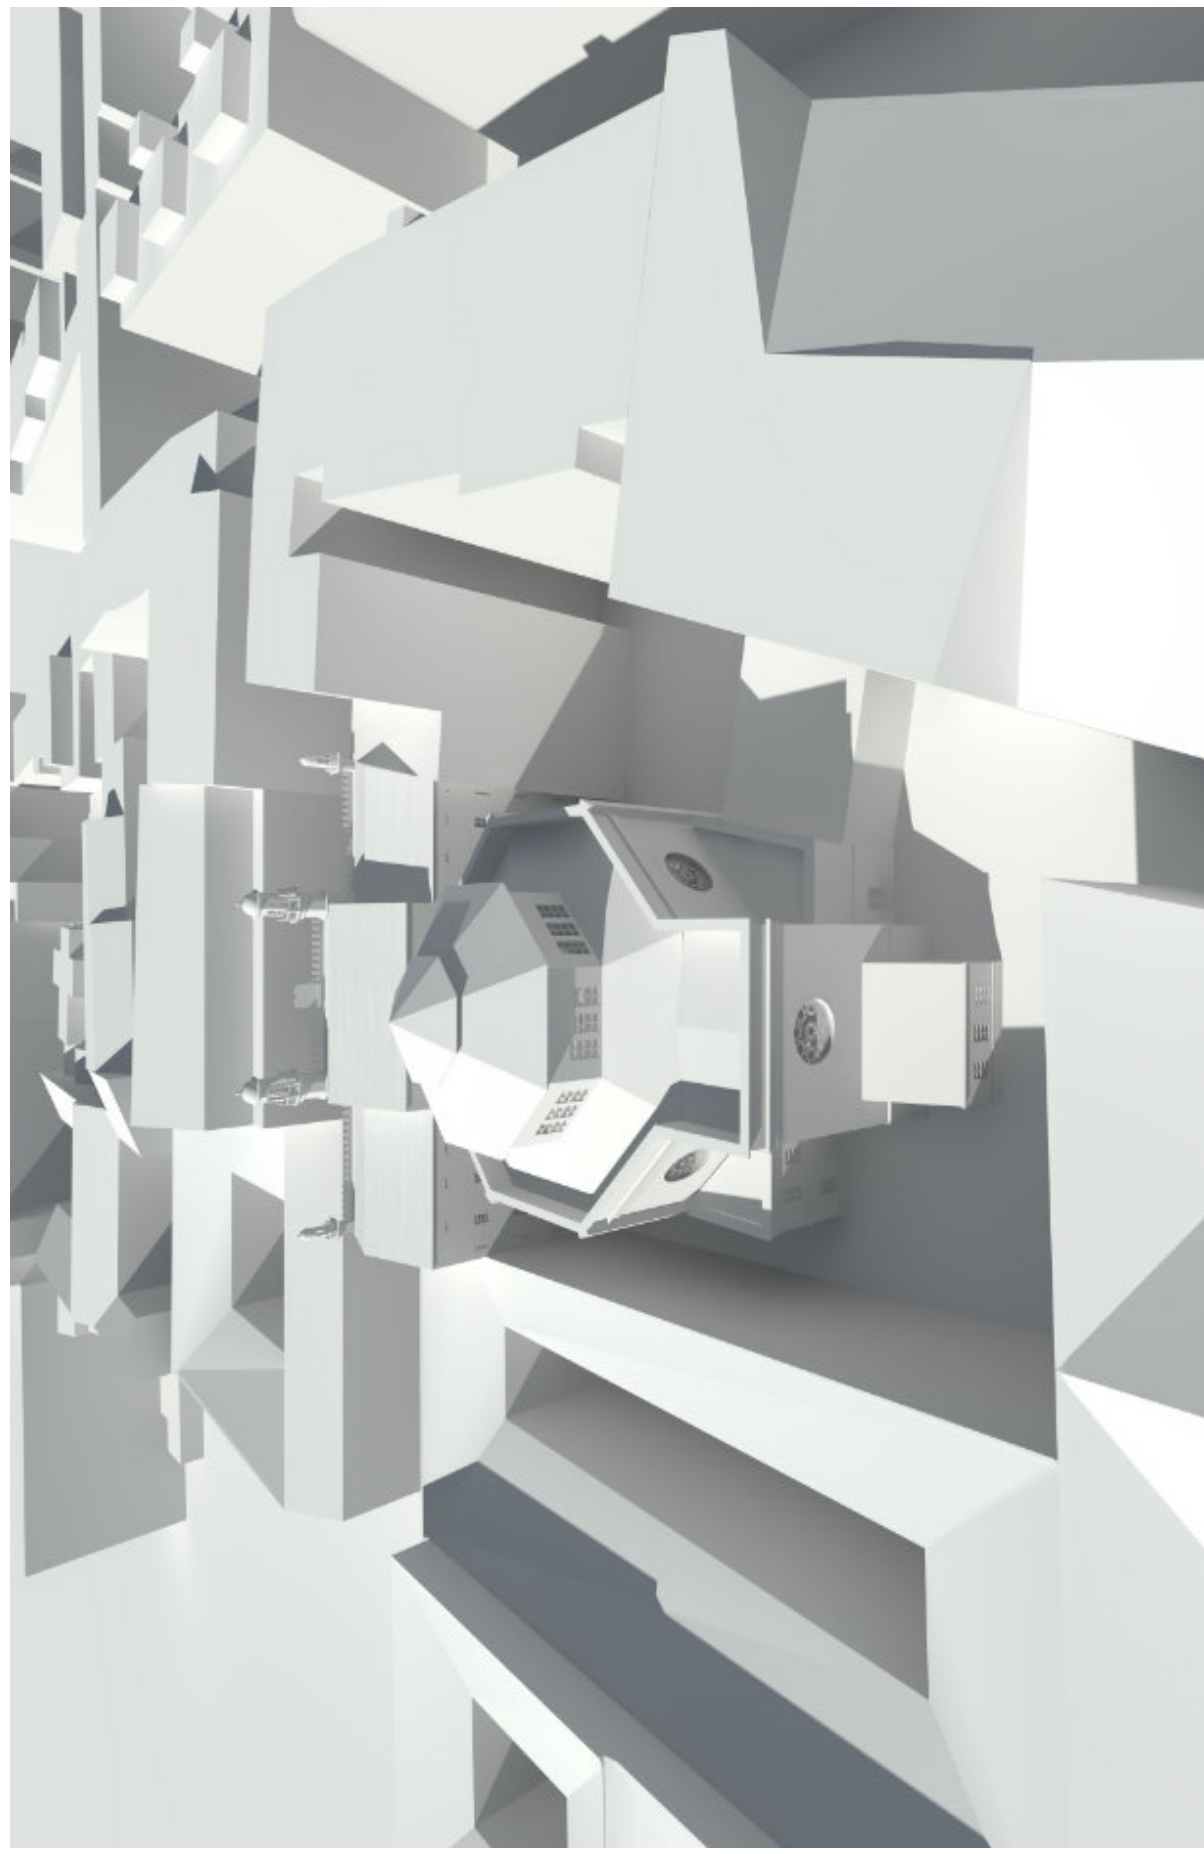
4b.: Außen 03 - Ostfassade, Städtebauliche Situation, Weofßrendering.
